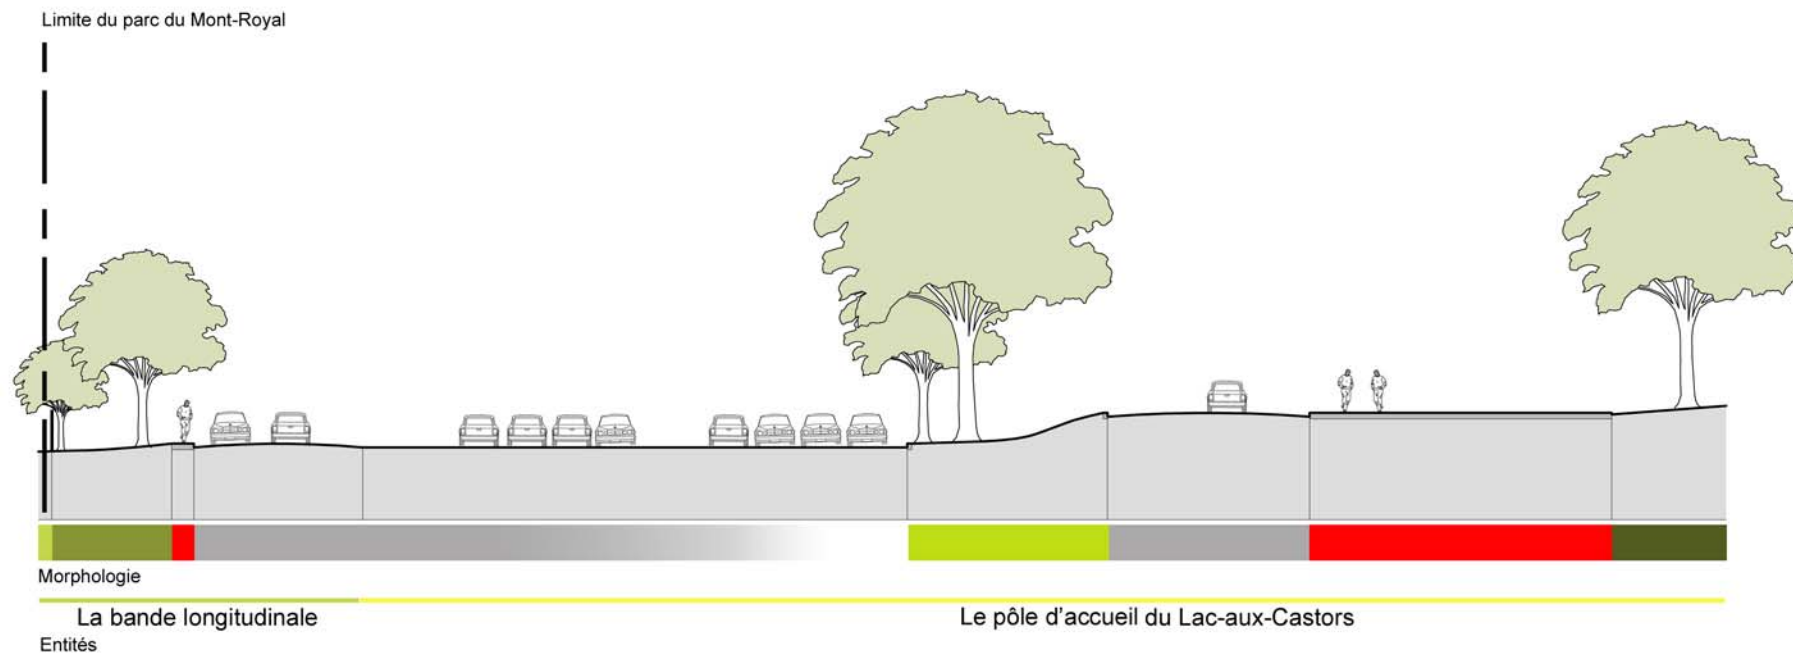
Coupe transversale 04, échelle 1:500, la bande longitudinale et le pôle d'accueil du Lac-aux-Castors
